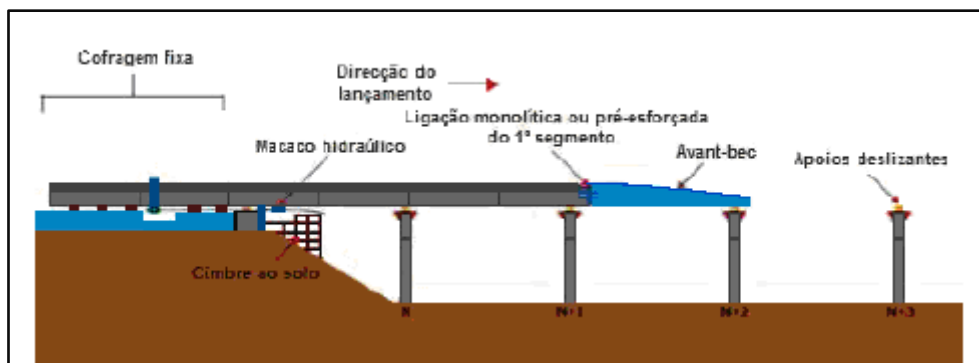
Esquema de construção do tabuleiro de uma ponte com recurso ao processo construtivo de lançamento incremental ou deslocamentos sucessivos [4]
